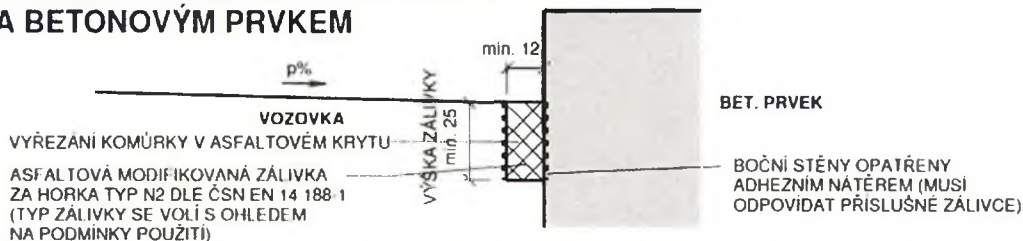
DETAILY NAPOJENÍ BETONOVÝCH PRVKŮ K HRANĚ ZPEVNĚNÍ VOZOVKY
